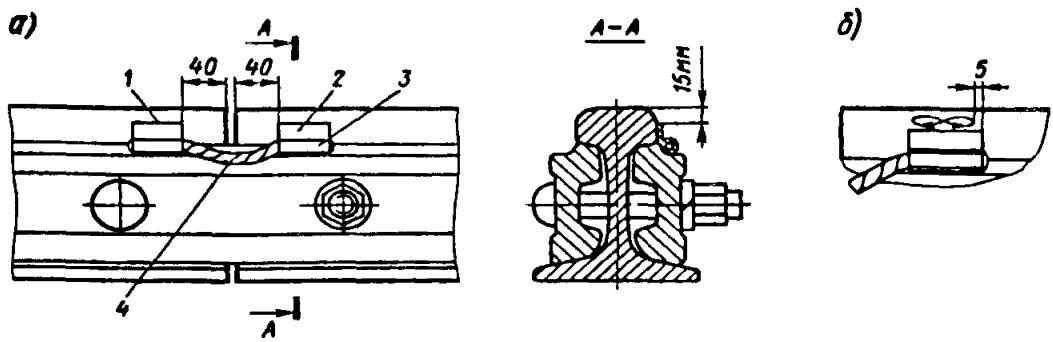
Схема установки (а) и приварки (б) медного соединителя фартучного типа к головке рельса:
